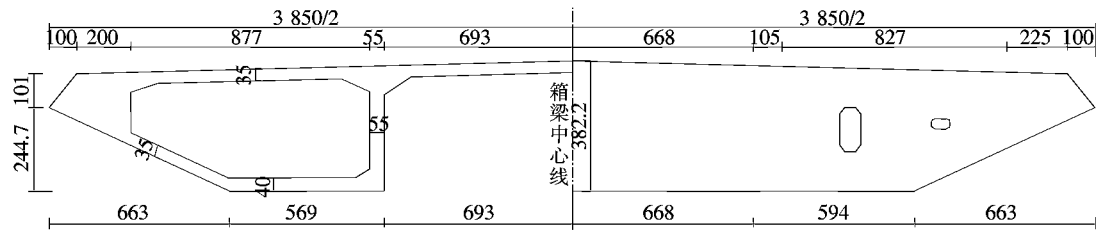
北边跨混凝土标准梁段横截面图(单位:cm)
